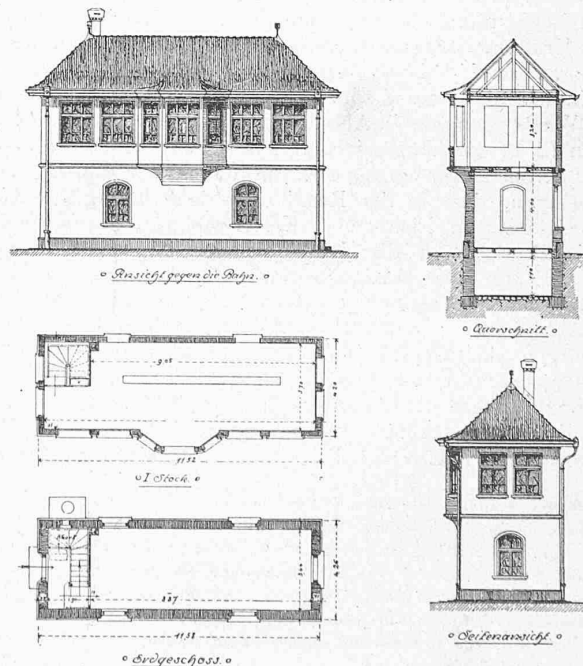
Stellwerkhäuschen der S. B. B. im Bahnhof Baden. Ansichten, Grundrisse und Schnitt.
